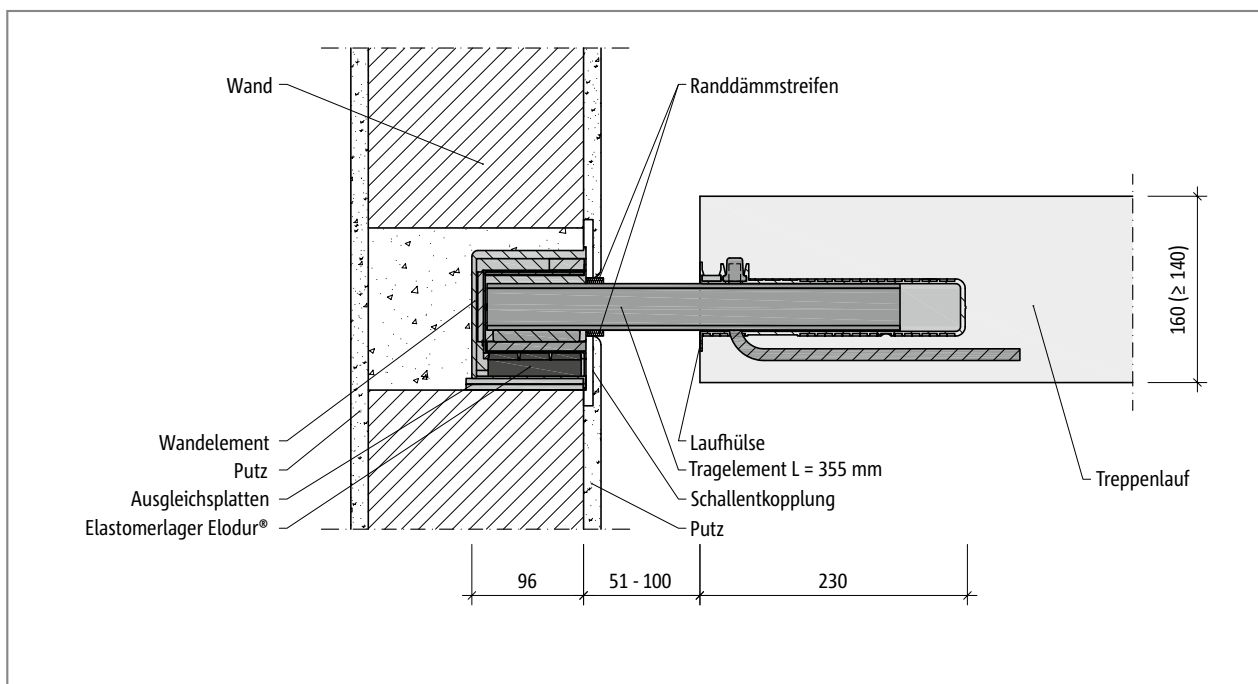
Schöck Tronsole® Typ Q-FV-XL oder Q-A2-XL: Einbauschnitt mit Elementtreppenlauf
